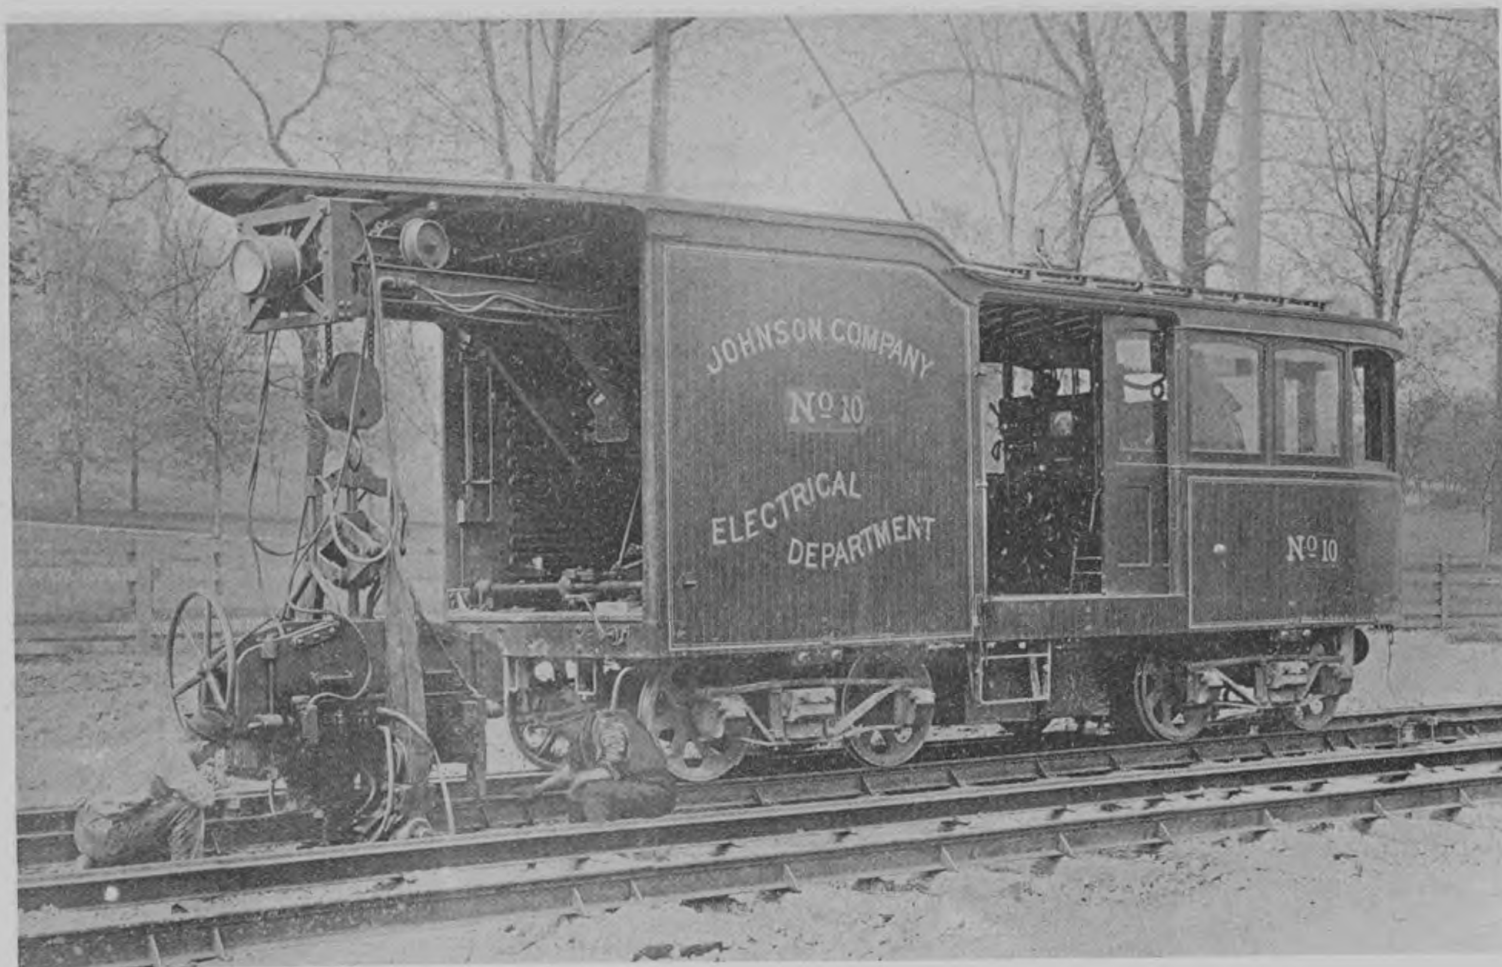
WAGON ÉLECTRIQUE POUR LA SOUDURE DES RAILS
